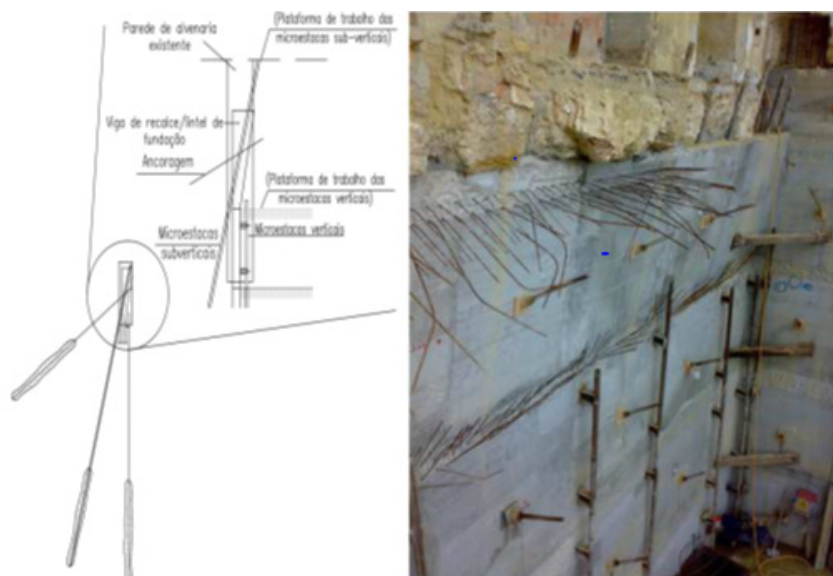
Pormenor da estabilização da viga de coroamento à esquerda e vista da estrutura de contenção à direita (Pereira et al, 2012)
